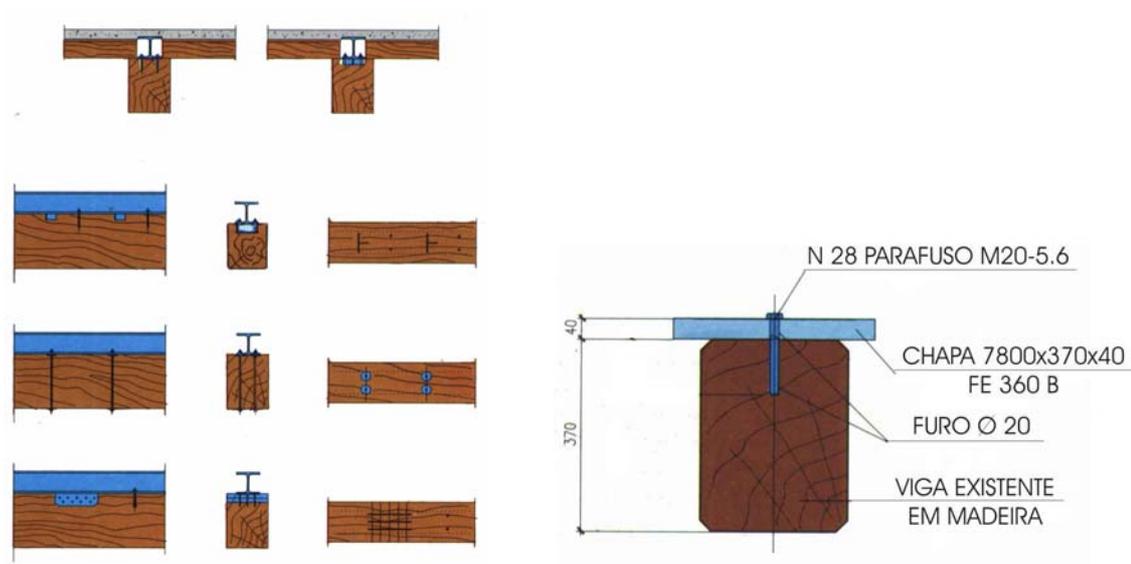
Tipos de reforço na parte superior da viga de madeira
